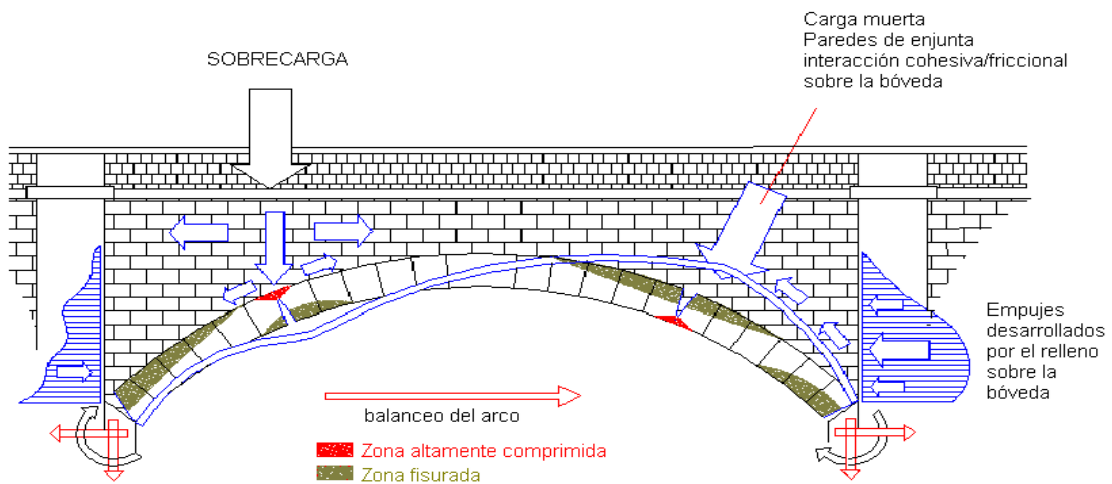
Comportamiento de un puente arco de mampostería a una sobrecarga aplicada.
